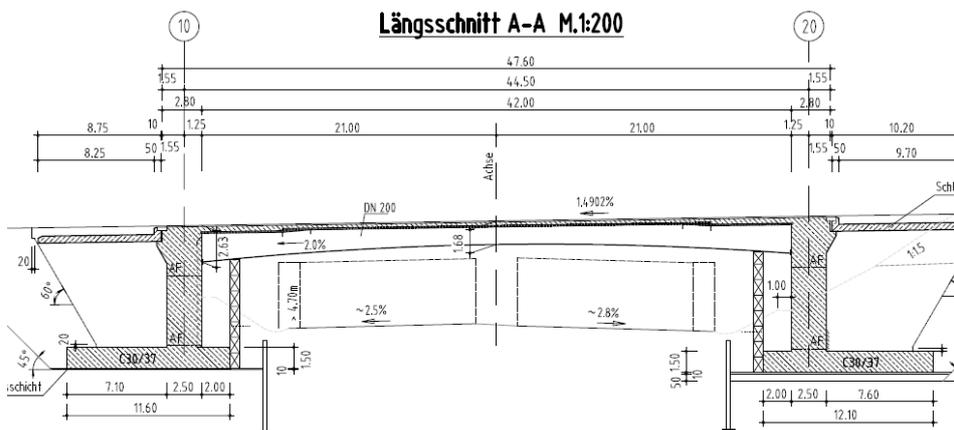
Längsschnitt Stahlverbundbrücke mit Montagestützen in der Entwurfsplanung
